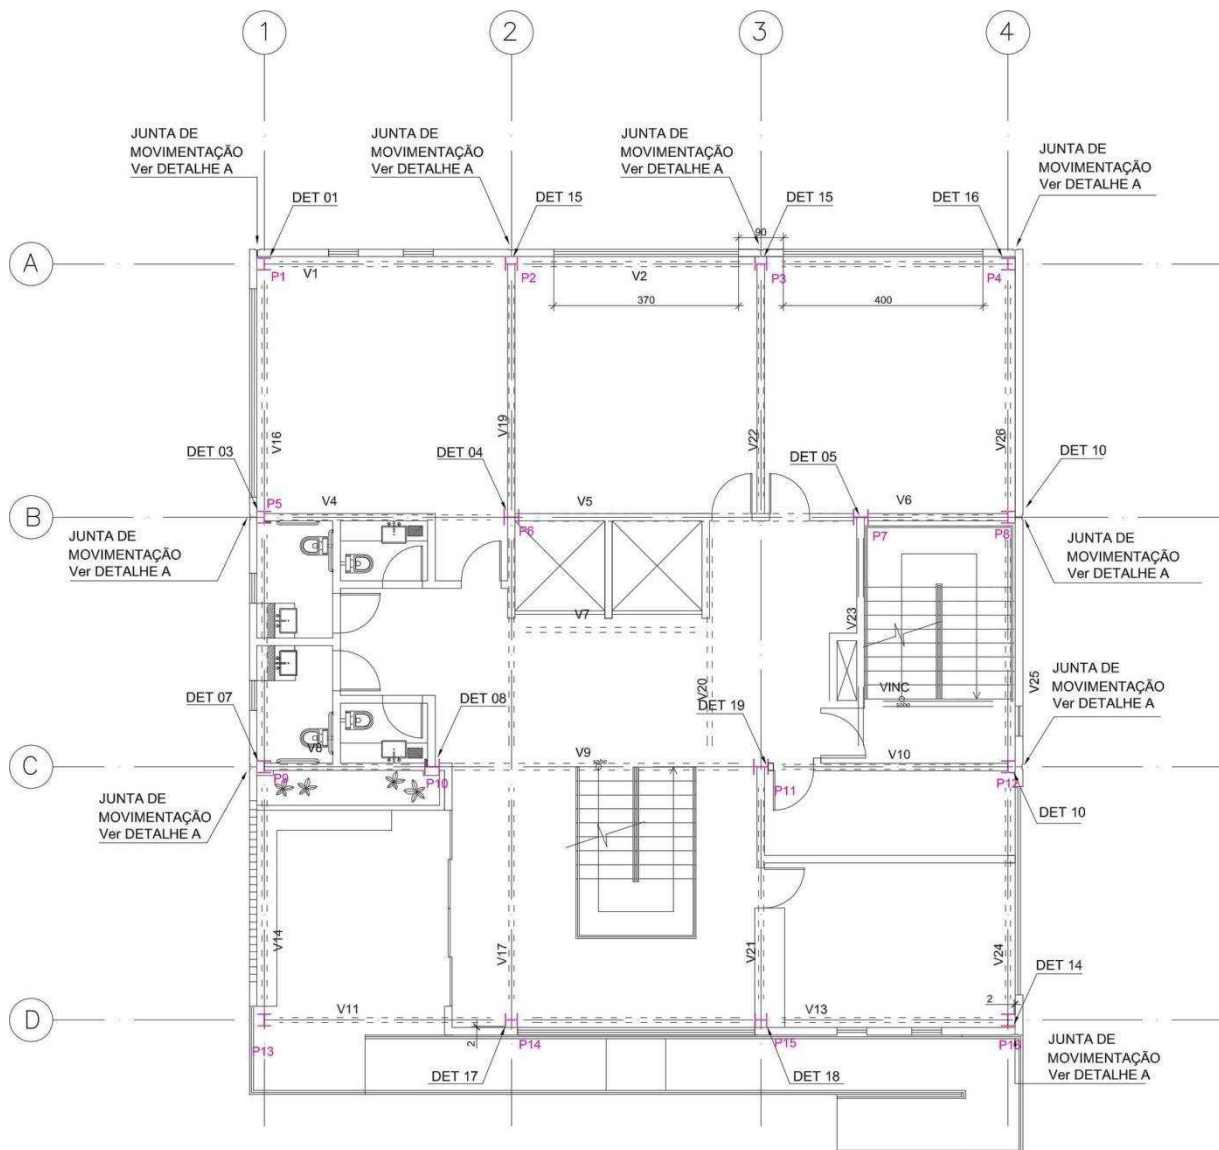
Planta do pavimento térreo do projeto de alvenaria do Edifício de Educação e Serviço Social da IPV.
